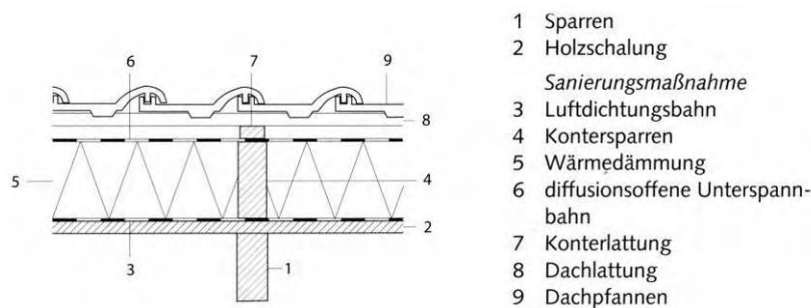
Aufsparrendämmung mit sichtbaren Sparren bei Erneuerung der Dachdeckung
